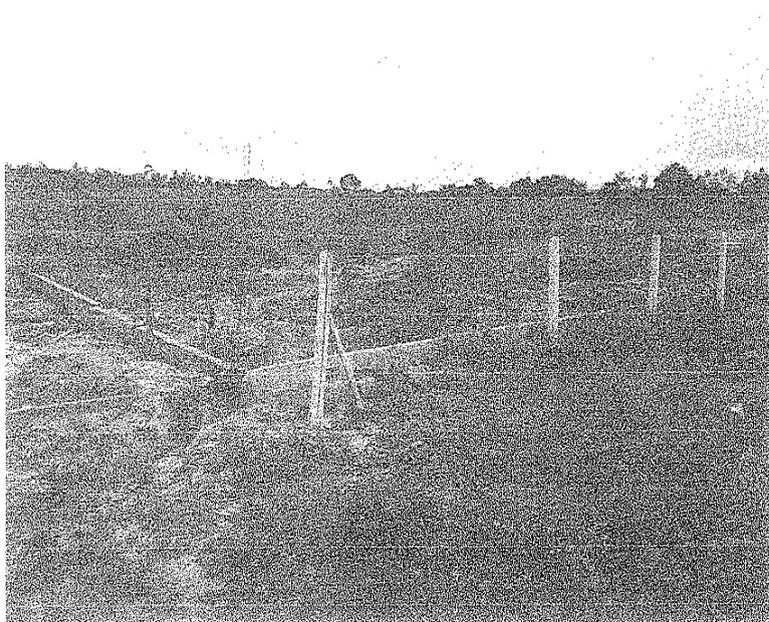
Vista do vértice da lateral direita frontal do terreno.
